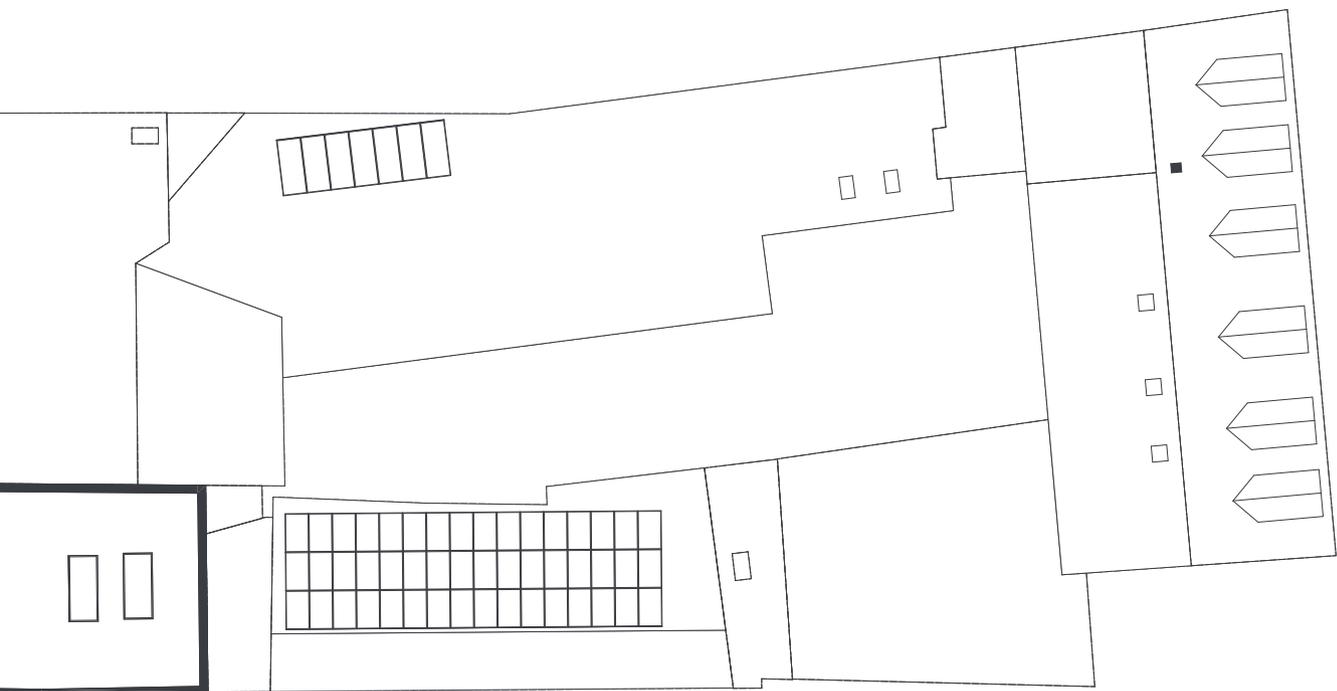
| Grundriss Dachaufsicht Bestand
